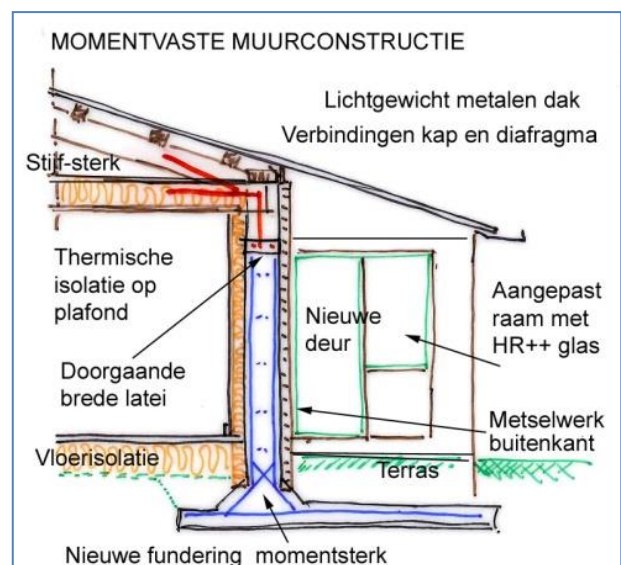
De open façade van beide gebouwdelen hebben geen sterkte tegen zijwaartse bevingsbelastingen. Door een sterk muur element in de linker terras façade te bouwen kan dit probleem daar worden opgelost.
